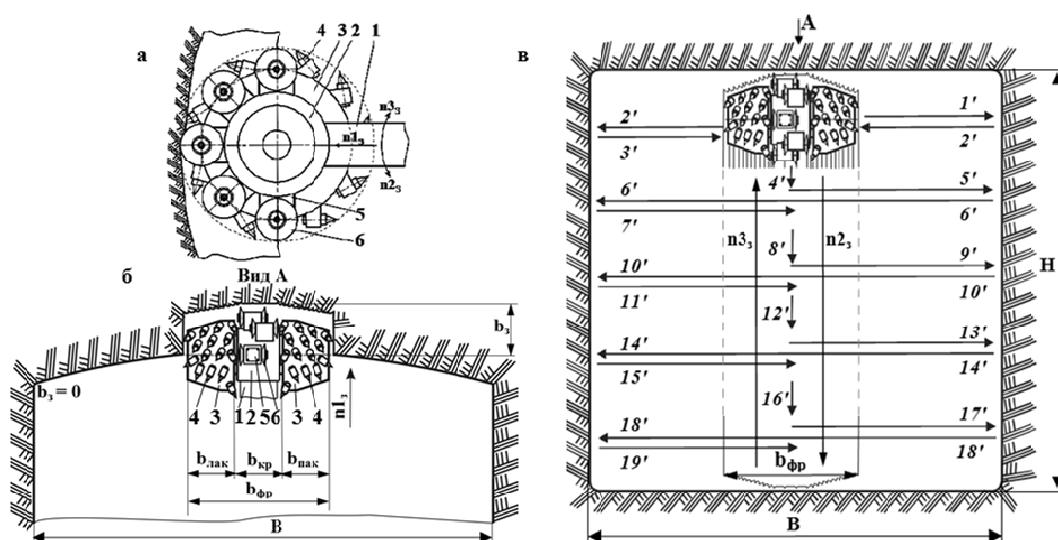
Исполнительный орган с резцовыми и дисковыми инструментами: а – зона размещения дисковых инструментов; б – процесс центральной зарубки; в – последовательность обработки проходческого забоя
